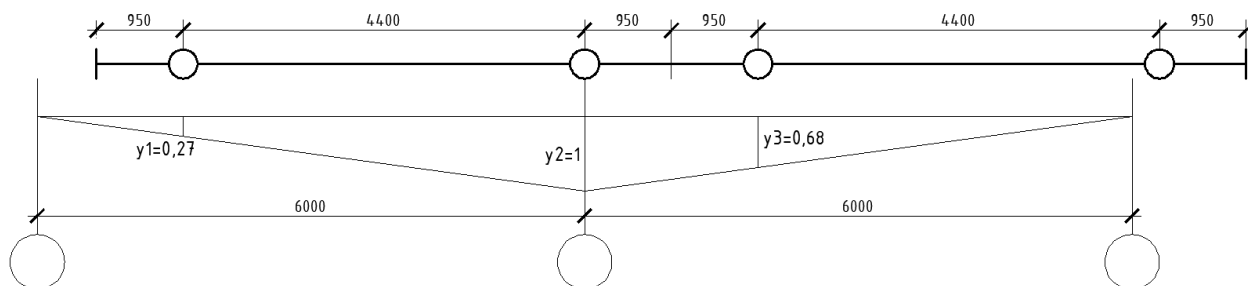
Схема розташування двох зближених мостових кранів на підкрановій балці для визначення кранових навантажень на поперечну раму будівлі.
